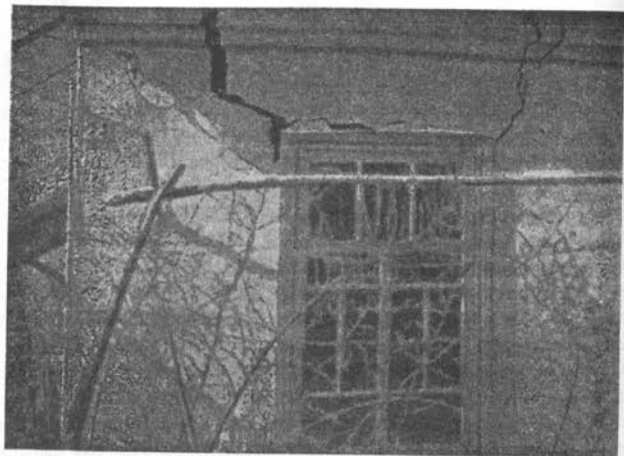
Трещины в стене жилого дома вследствие усадки грунтового основания (пос. Черноморский Краснодарского края)
